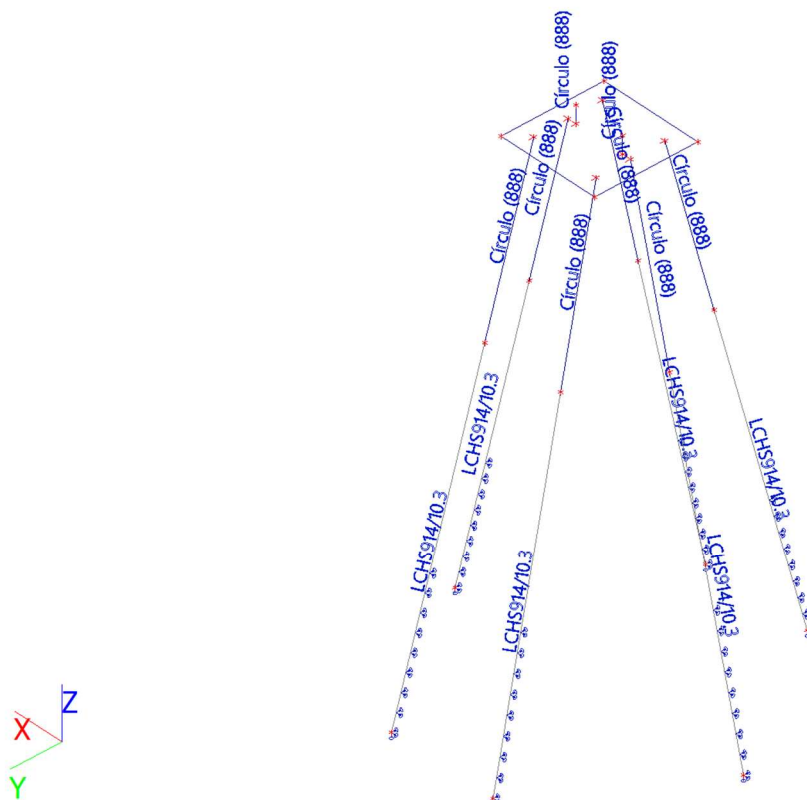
Modelo estrutural com definição das seções transversais – Vista isométrica – DAM
